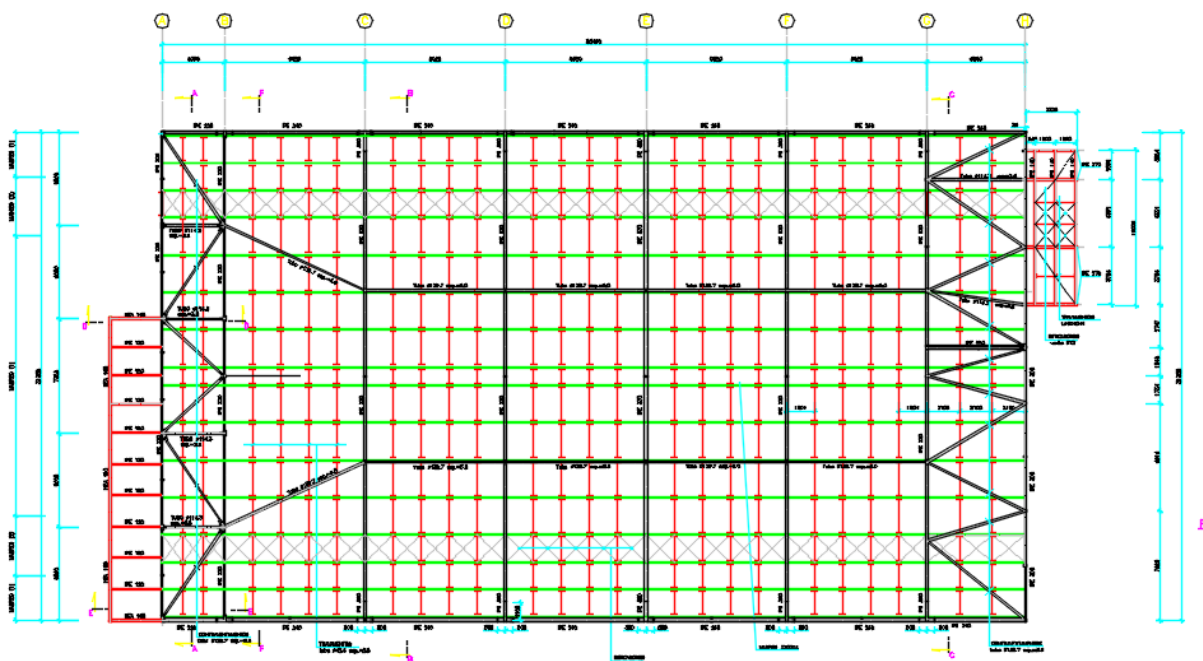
Planta estrutural da cobertura metálica existente.
